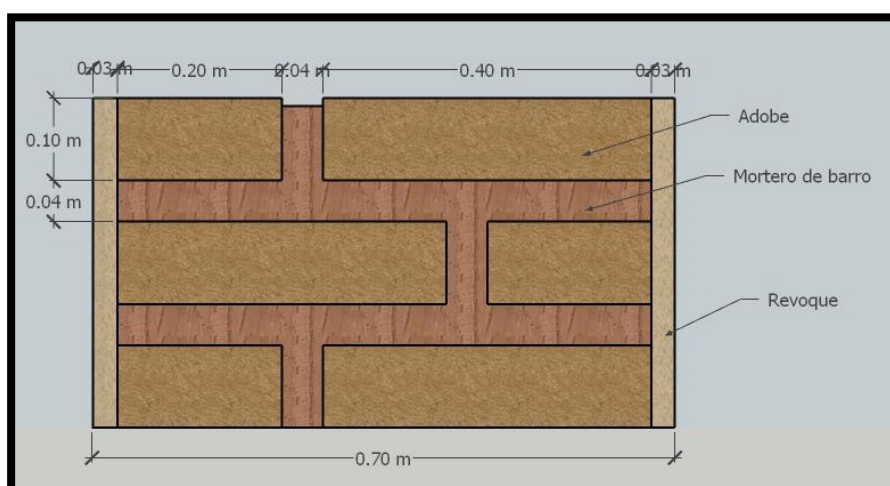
Medidas del muro de la hacienda Vichaycoto en corte. FUENTE: Elaboración propia.
